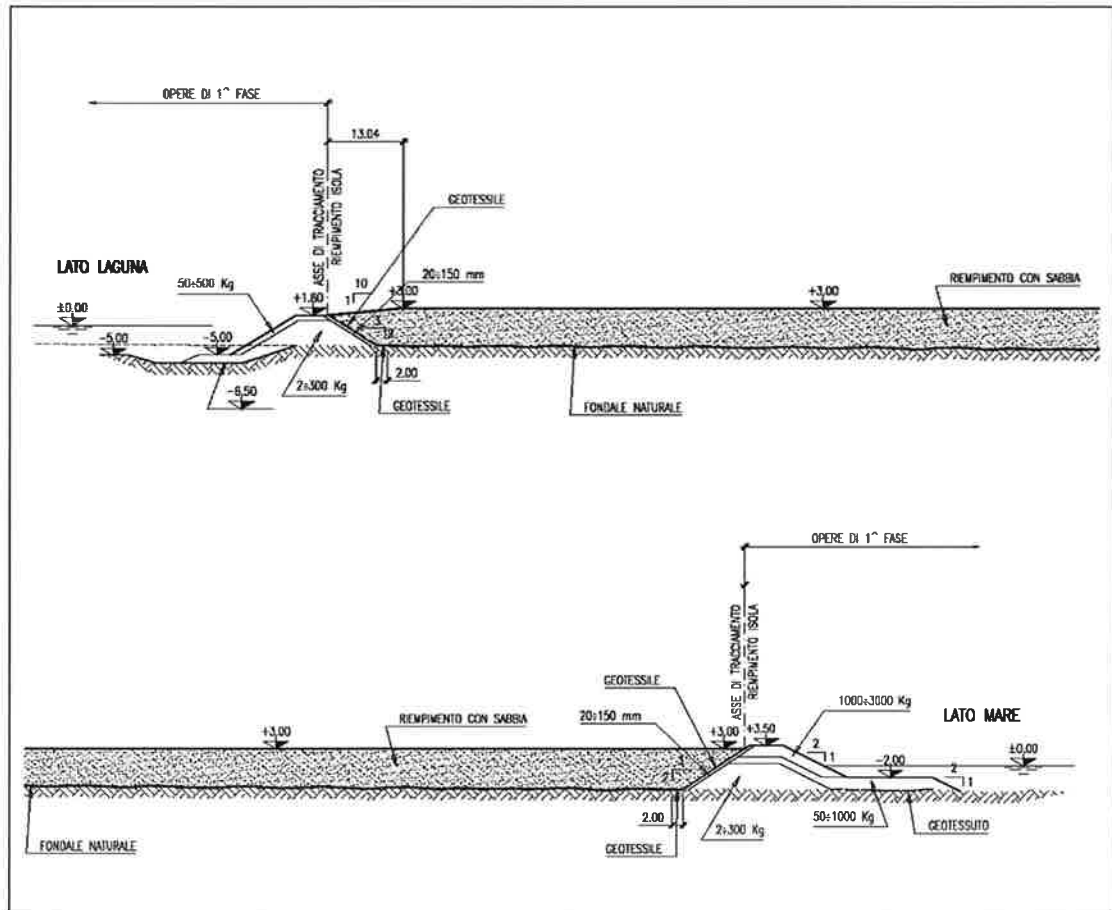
SEZIONE TIPO RIEMPIMENTO LATO MARE E LATO LAGUNA
